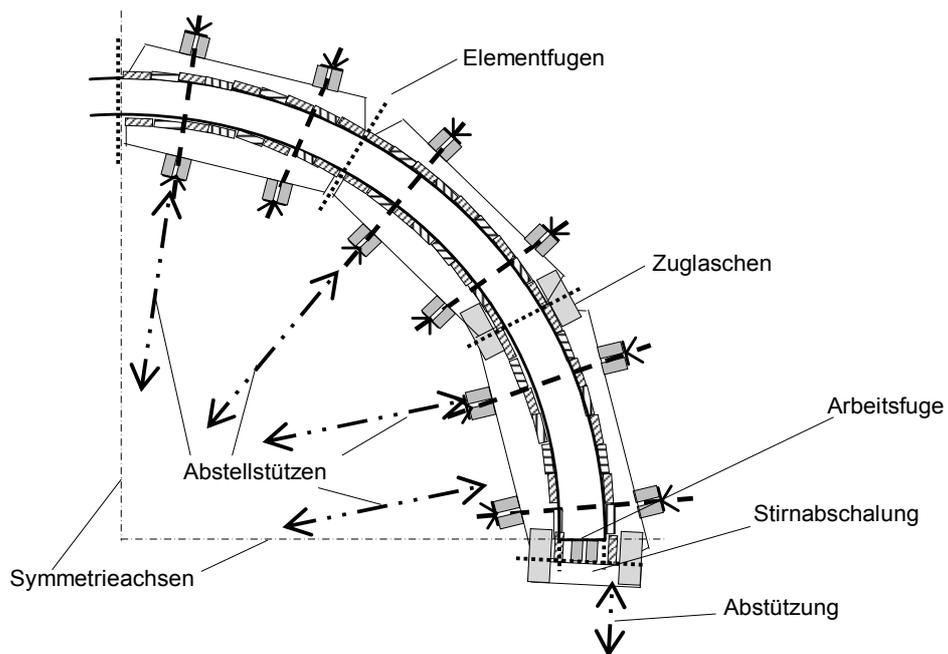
Teilgrundriss B: 1. Betonierabschnitt
